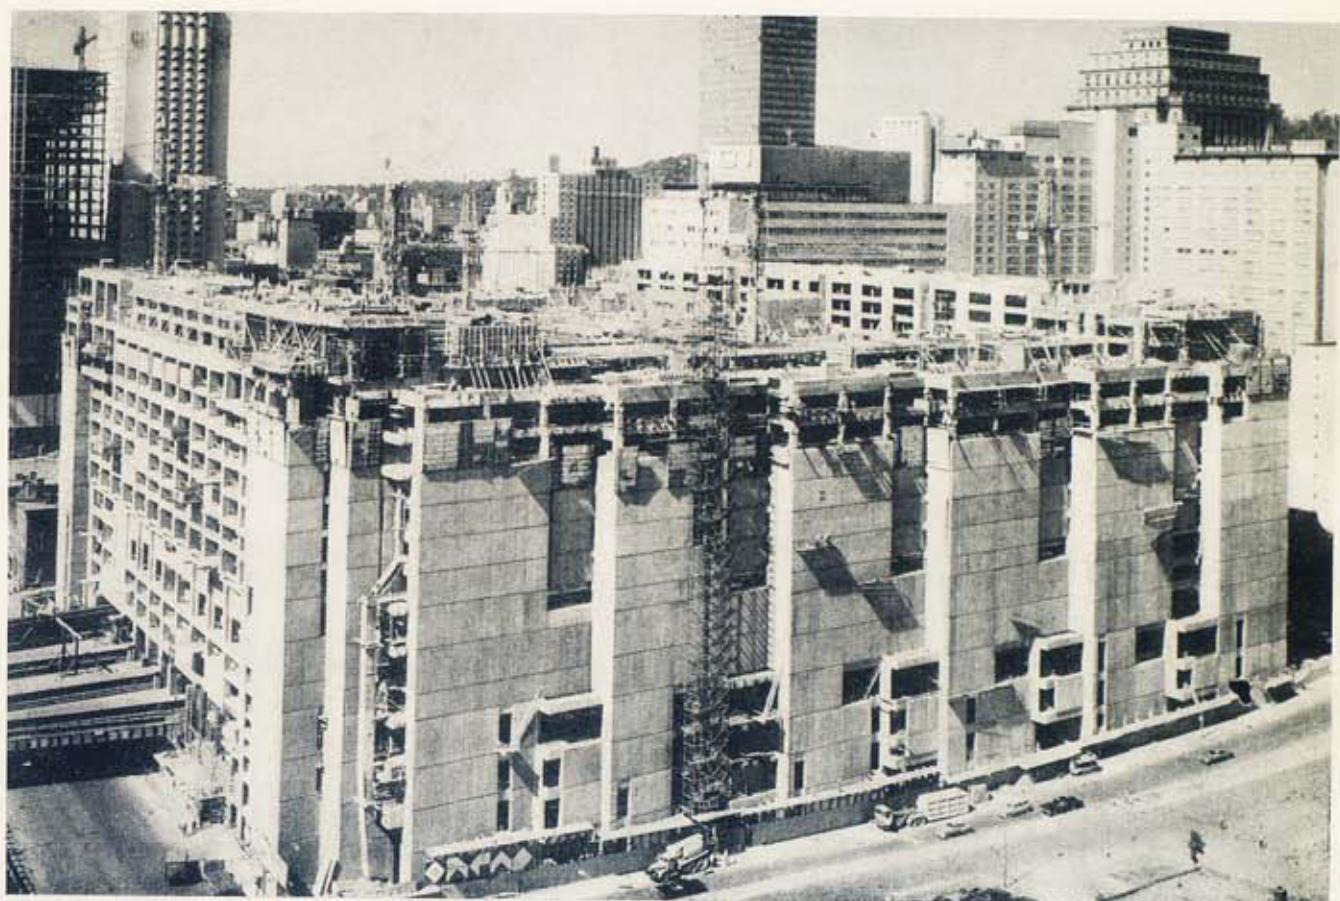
Place Bonaventure em construção, vista de leste, com o Château Champlain e a Place du Canada, à esquerda
